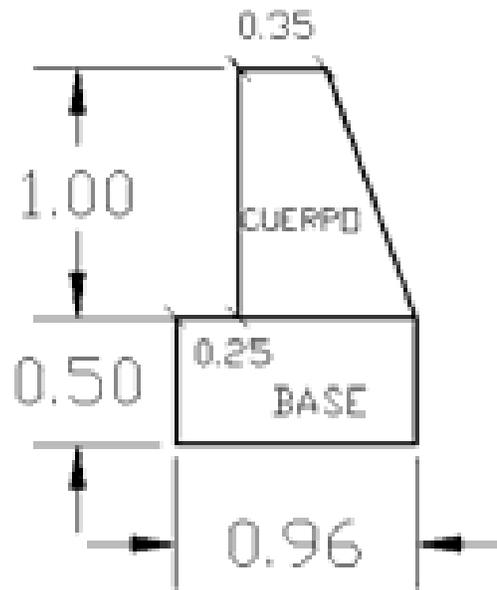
Muro de contención de la alcantarilla del kilometro 11+040.
